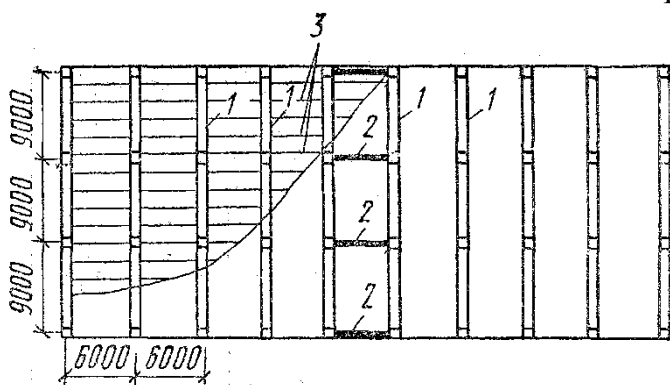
Конструктивный план многоэтажного каркасного промышленного здания
